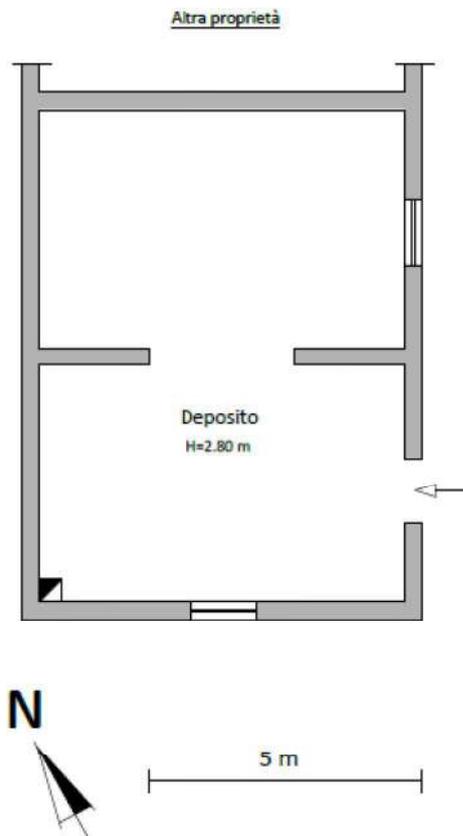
Planimetria dello stato reale dei luoghi – Deposito P.T.
